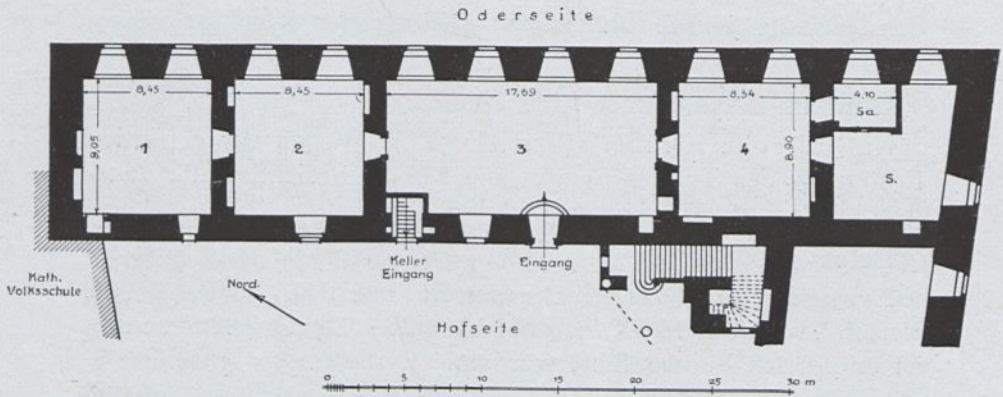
Schloß in Brieg. Grundriß des Oderflügels
